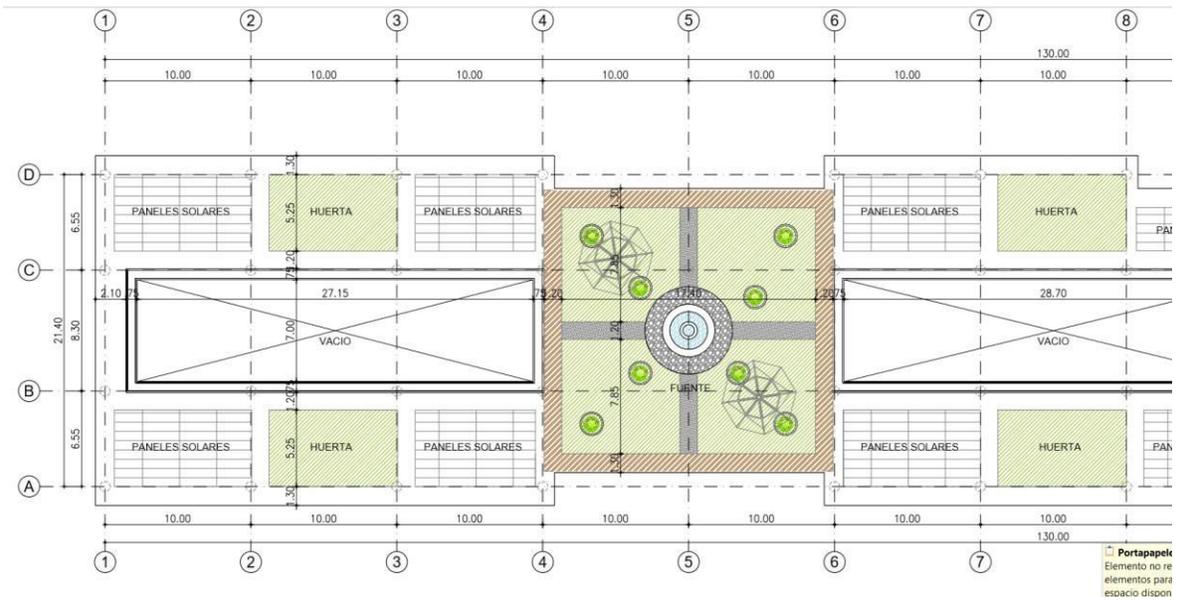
Propuesta de cubierta de apartamentos. Elaboración propia.
